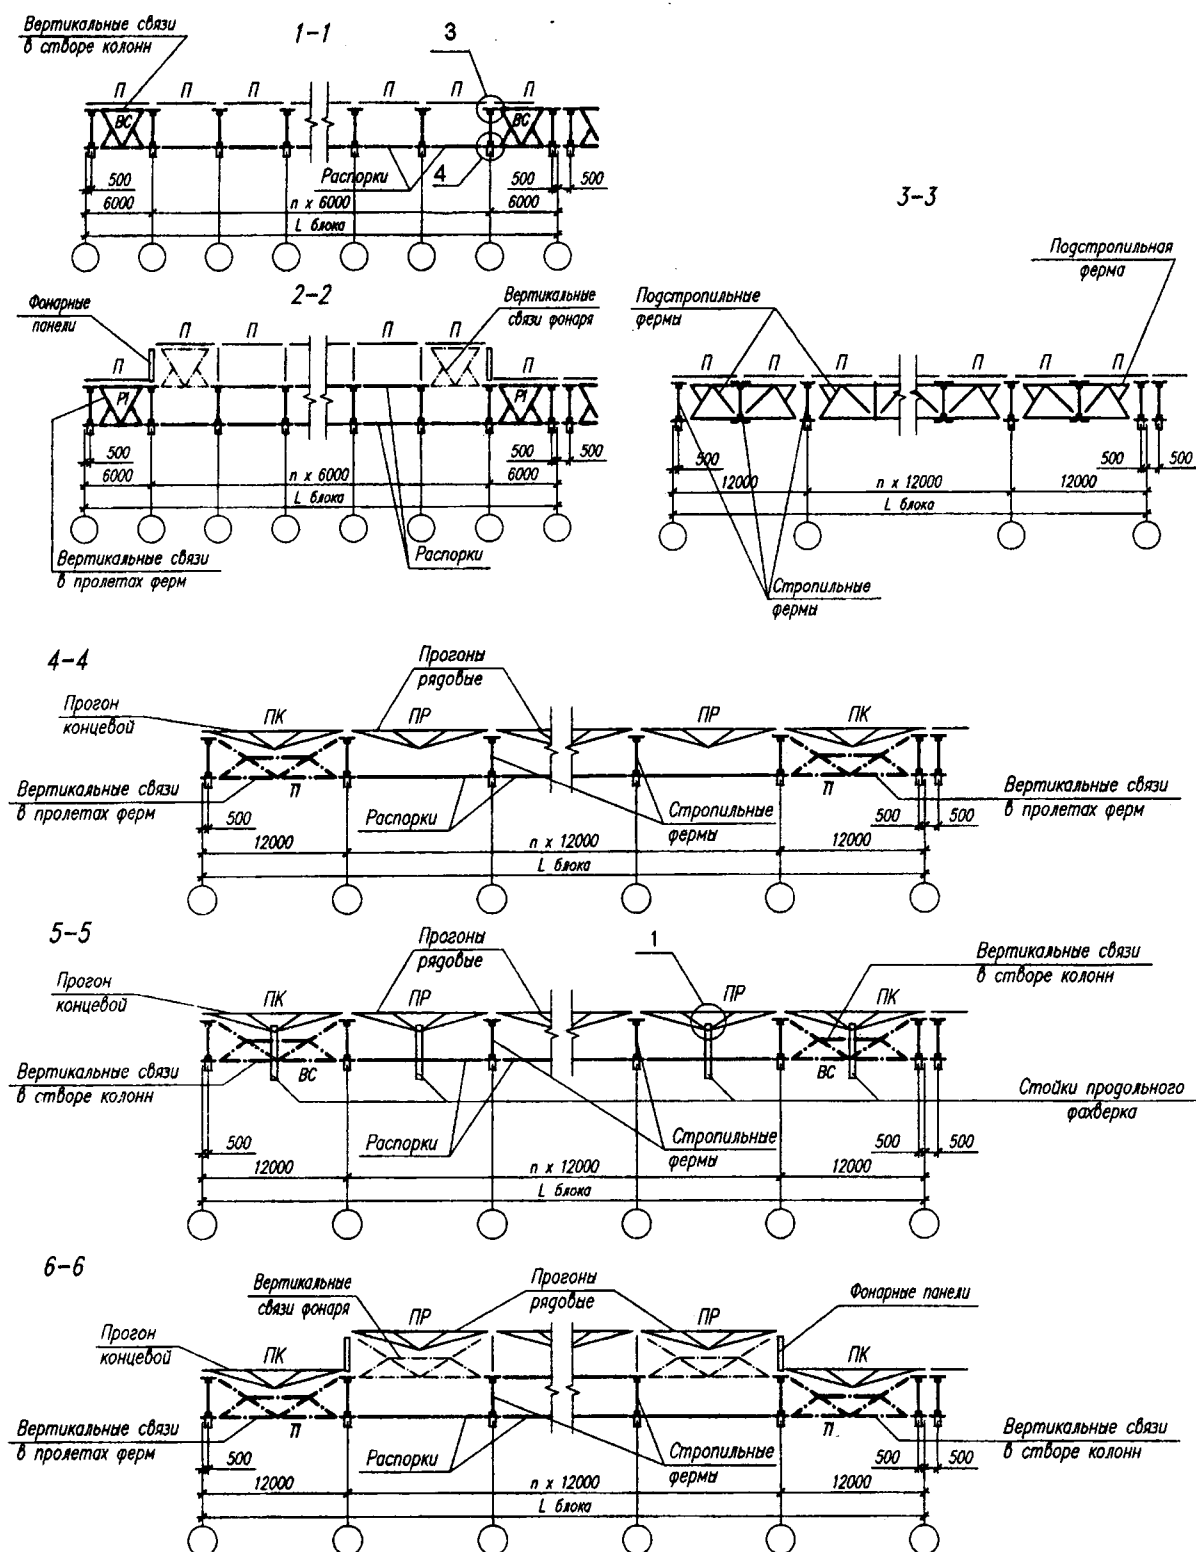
Схемы расположения вертикальных связей в покрытиях с применением профилированного настила (разрезы обозначены на рис. 5.1, 5.2)
